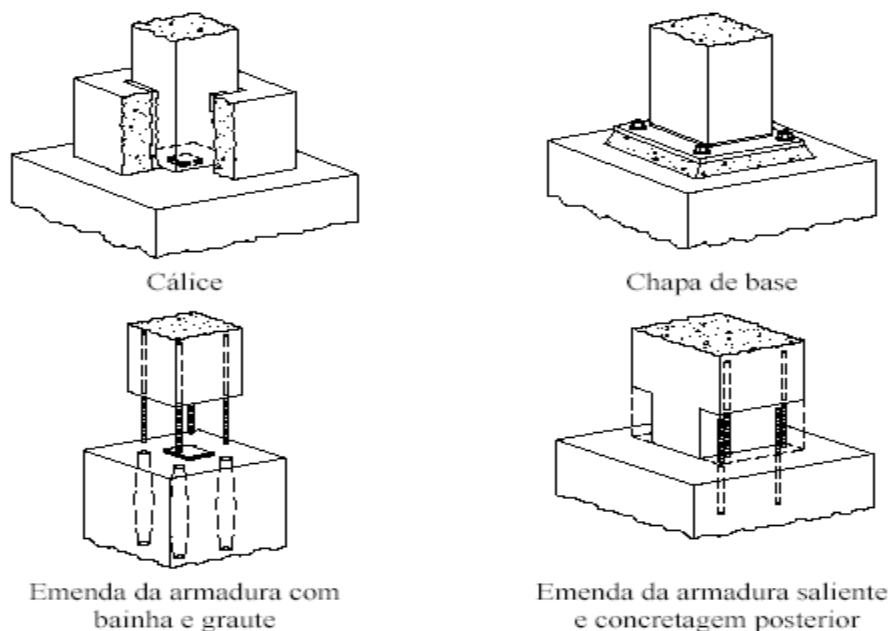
Tipos de ligações pré-moldadas pilar-fundação PCI (1988) – Adaptado por CANHA (2004).
